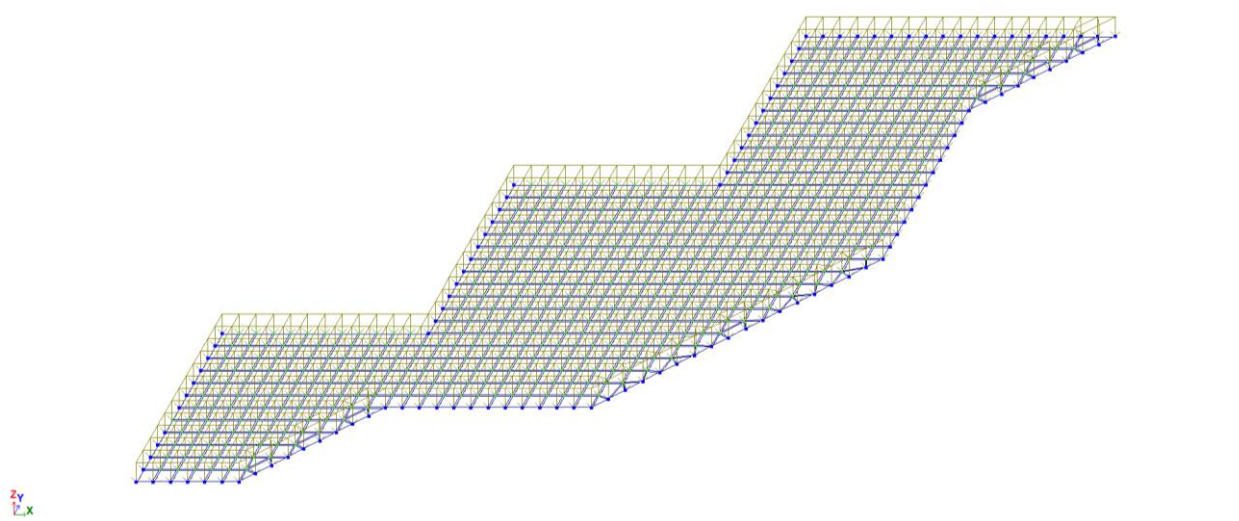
Расчетная схема плиты перекрытия с приложенной к ней нагрузкой
